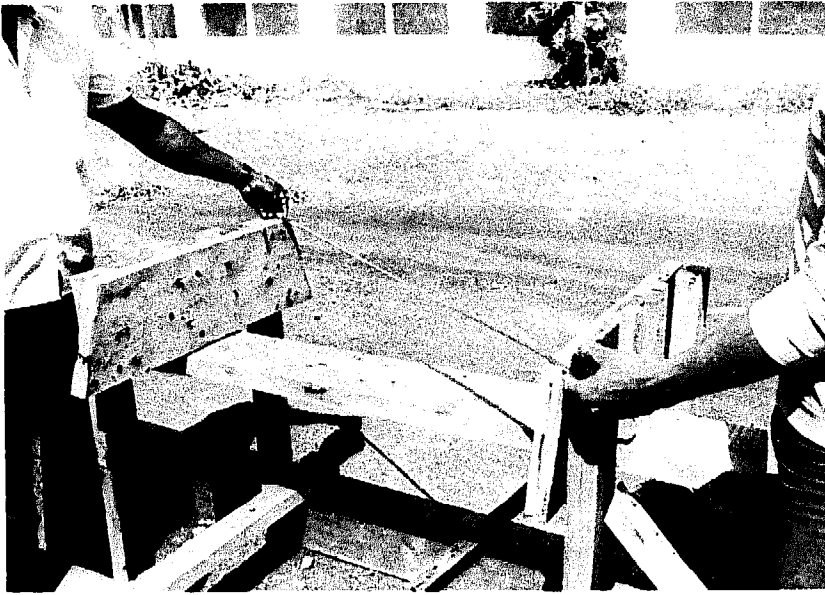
La position d'équerre des planches de montant se vérifie en mesurant du coin d'une planche au coin opposé de l'autre planche
